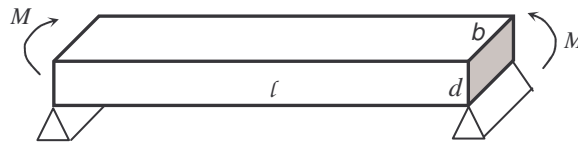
Schéma de la poutre sur des appuis simples en béton armé
